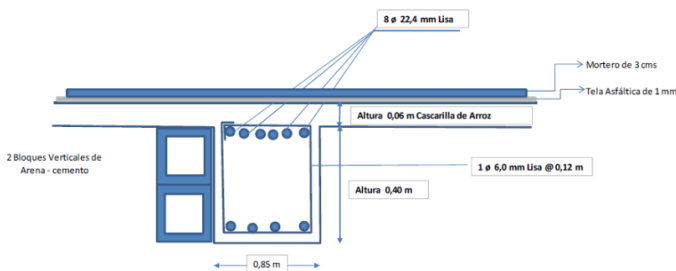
Viga B entre Ejes 5-6 Tercer Piso Segunda Placa
